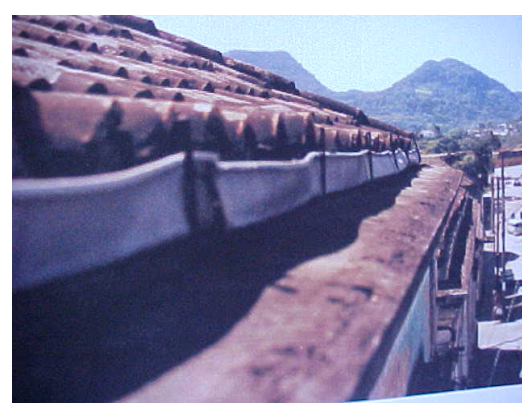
Parte superior da cimalha mostrando a calha metálica.
